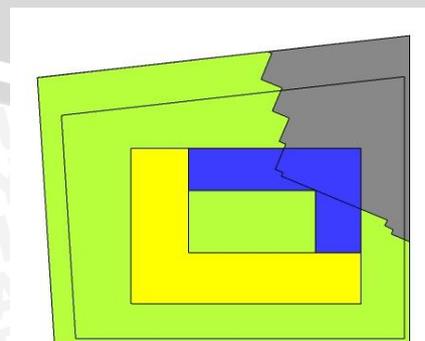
Layout bangunan mengikuti bentuk tapak
